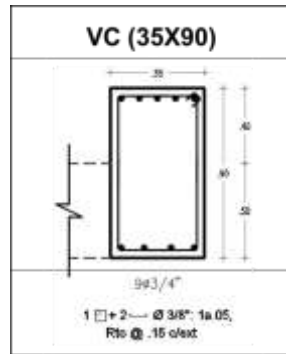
Pre dimensionamiento viga y platea de cimentación bloque sector
